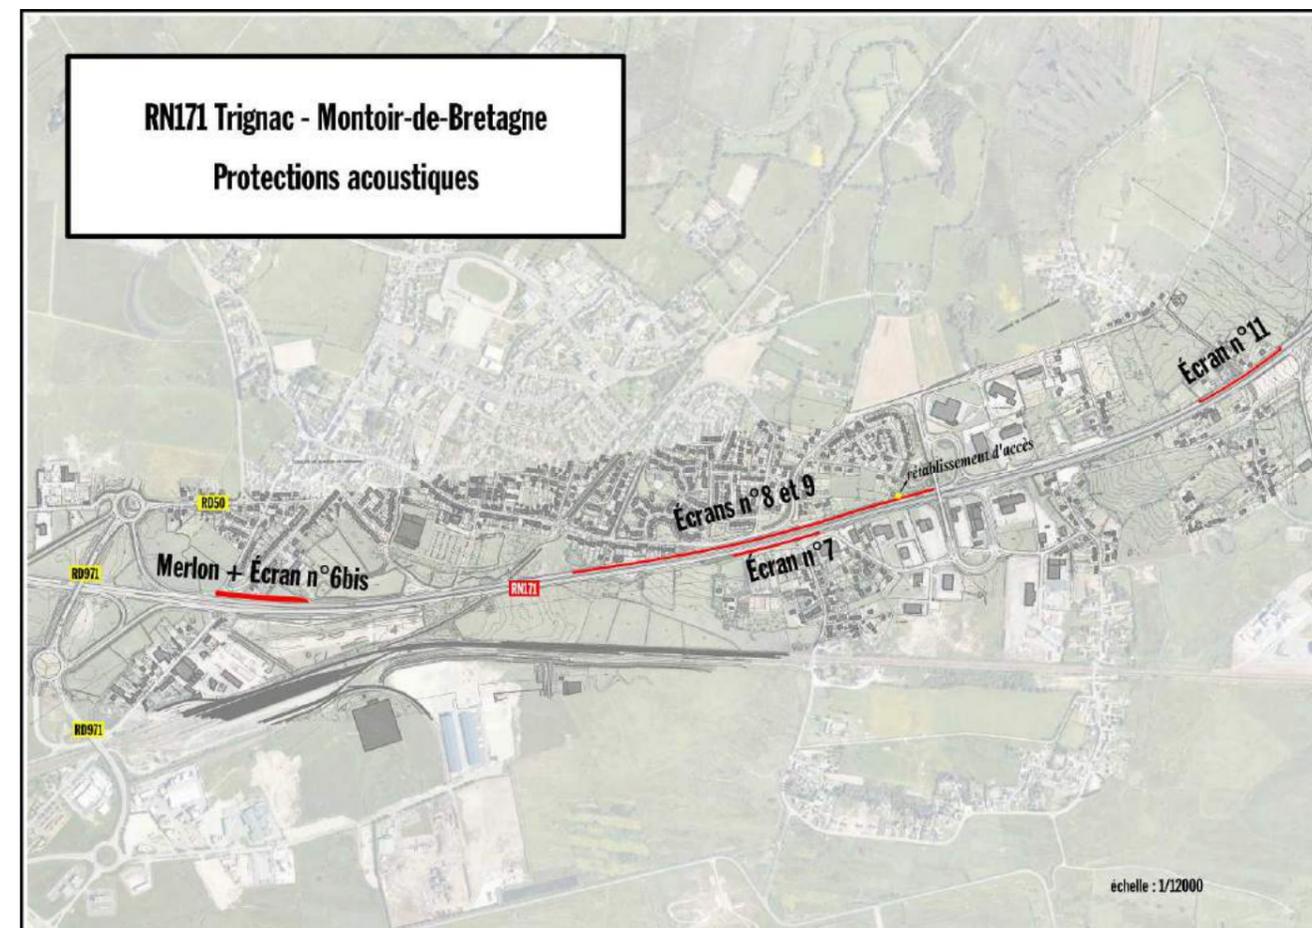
Plan Général des Travaux à Montoir-de-Bretagne
